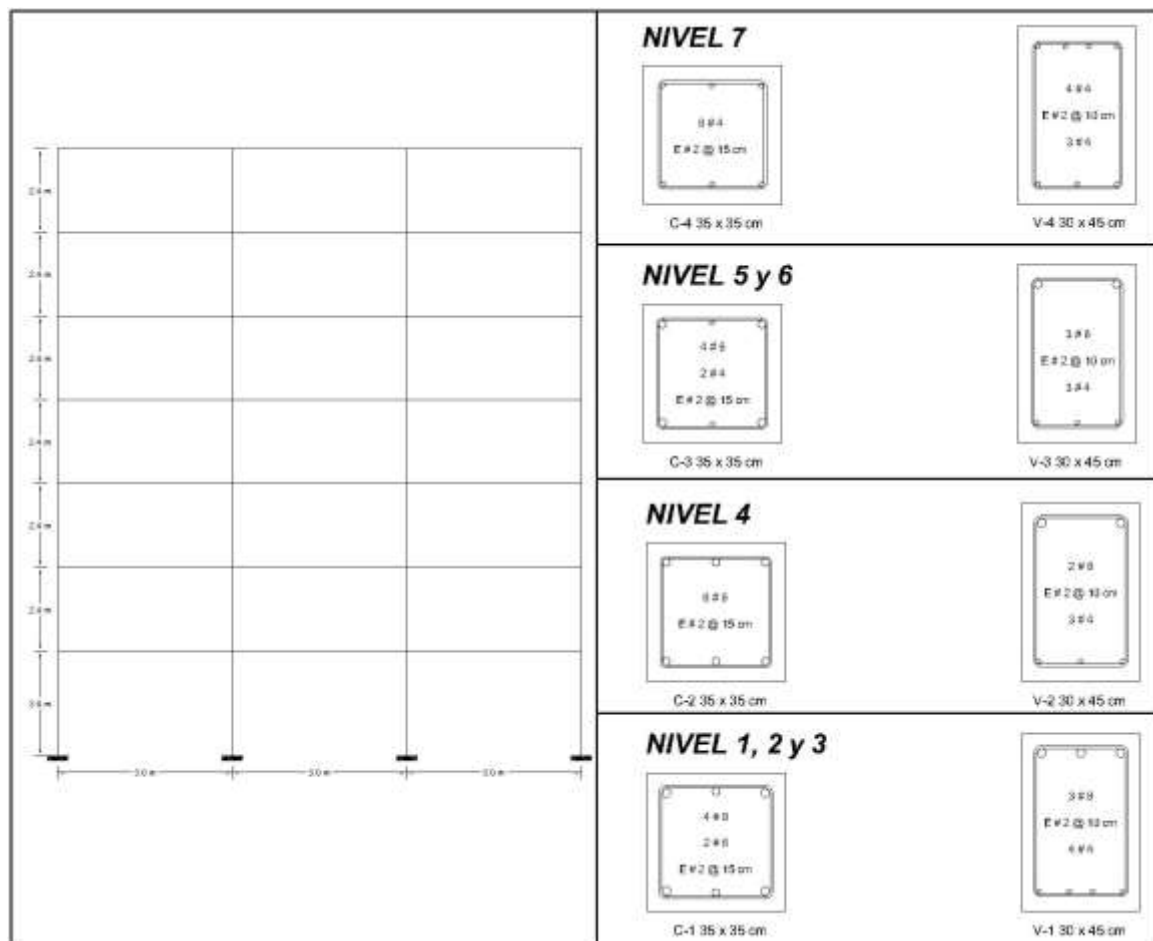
Armado de vigas y columnas para MCR de 7 con MDL diseñadas con el RCDF-1977 (DDF, 1977)
